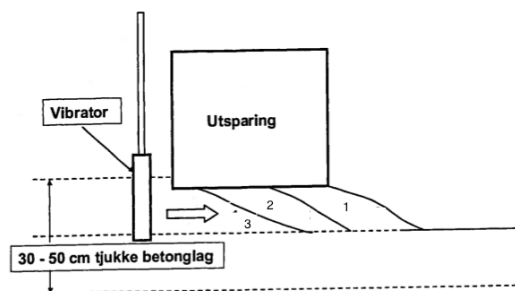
Fylling av betong rundt en dørutsparing [105]
